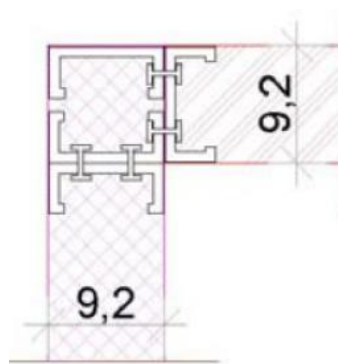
Ligação (SD). Fonte: Portal metálica, 2011.
